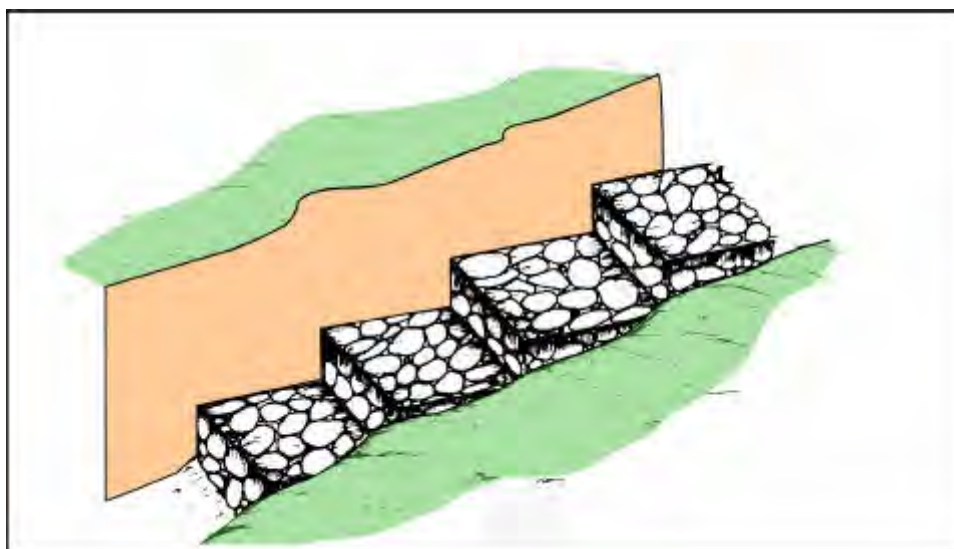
Protección del lecho de la quebrada con muros escalonados (andenes), utilizando bloques de roca o concreto armado.
